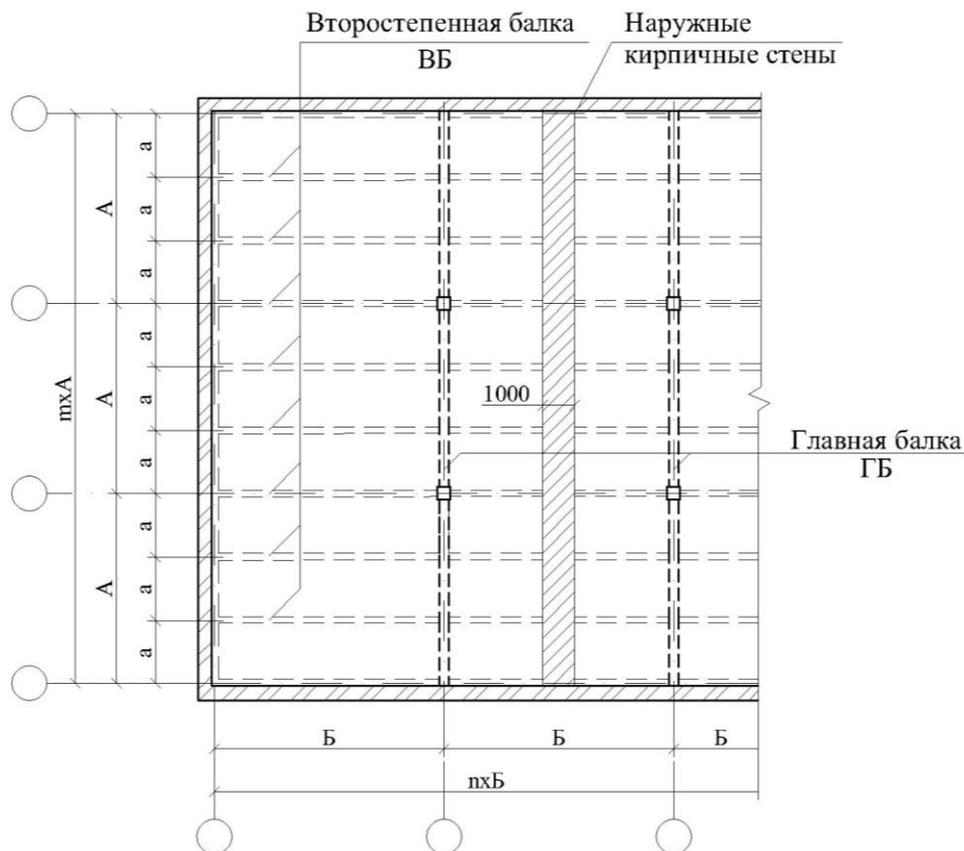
Конструктивная схема монолитного ребристого перекрытия
